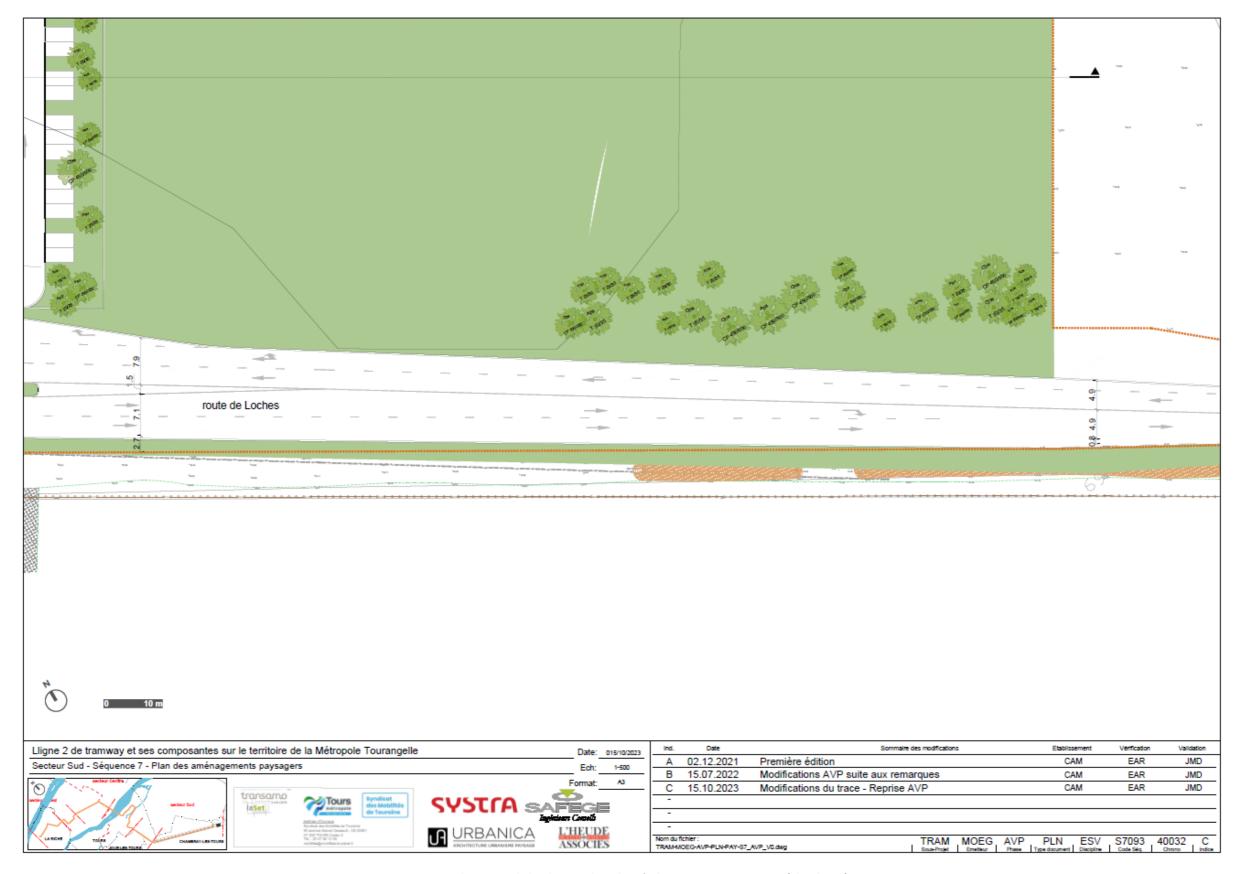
plan masse de localisation des arbres à abattre – P+R La Papoterie (planche 21)
